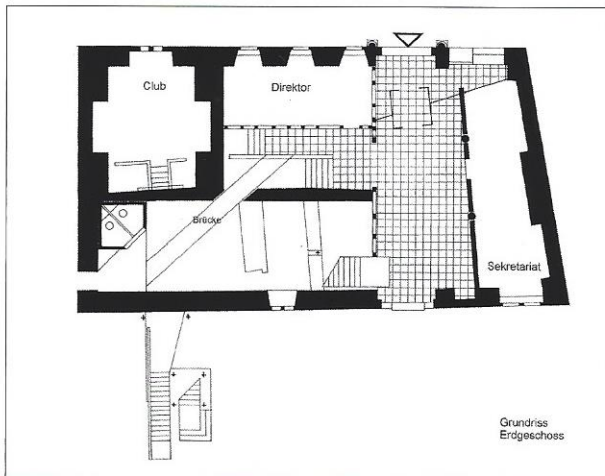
Arnstadt, Musikschule, Grundriss Erdgeschoss, 1995
